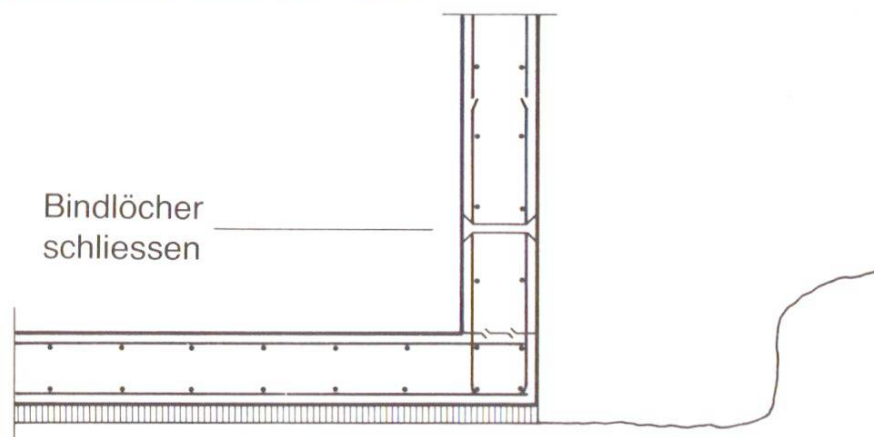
Querschnitt durch Anschluss Boden/Wand. Betonieren der Wand mit Mörtelvorlage.
